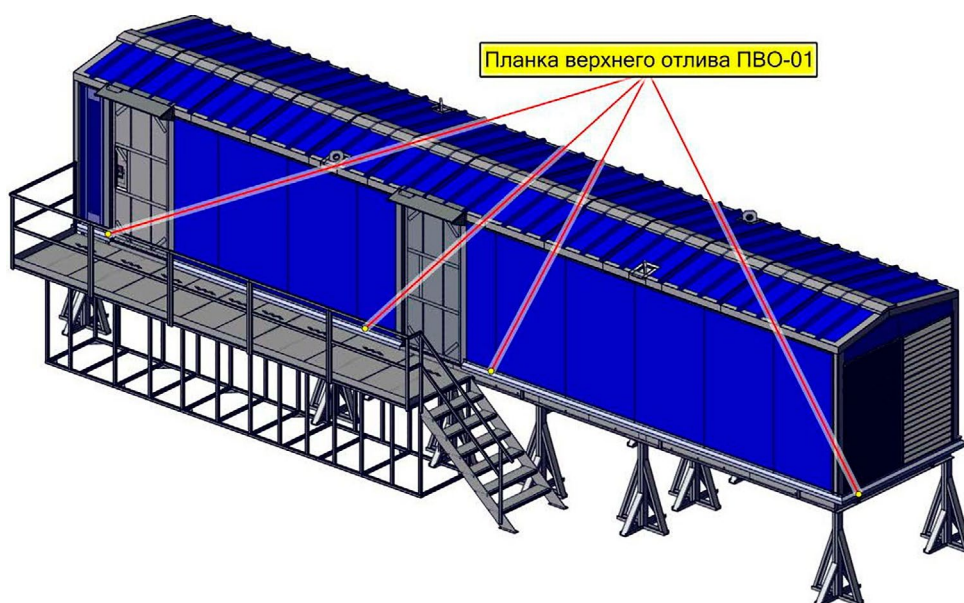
Общий вид преобразователя частоты со схемой установки планок отлива
